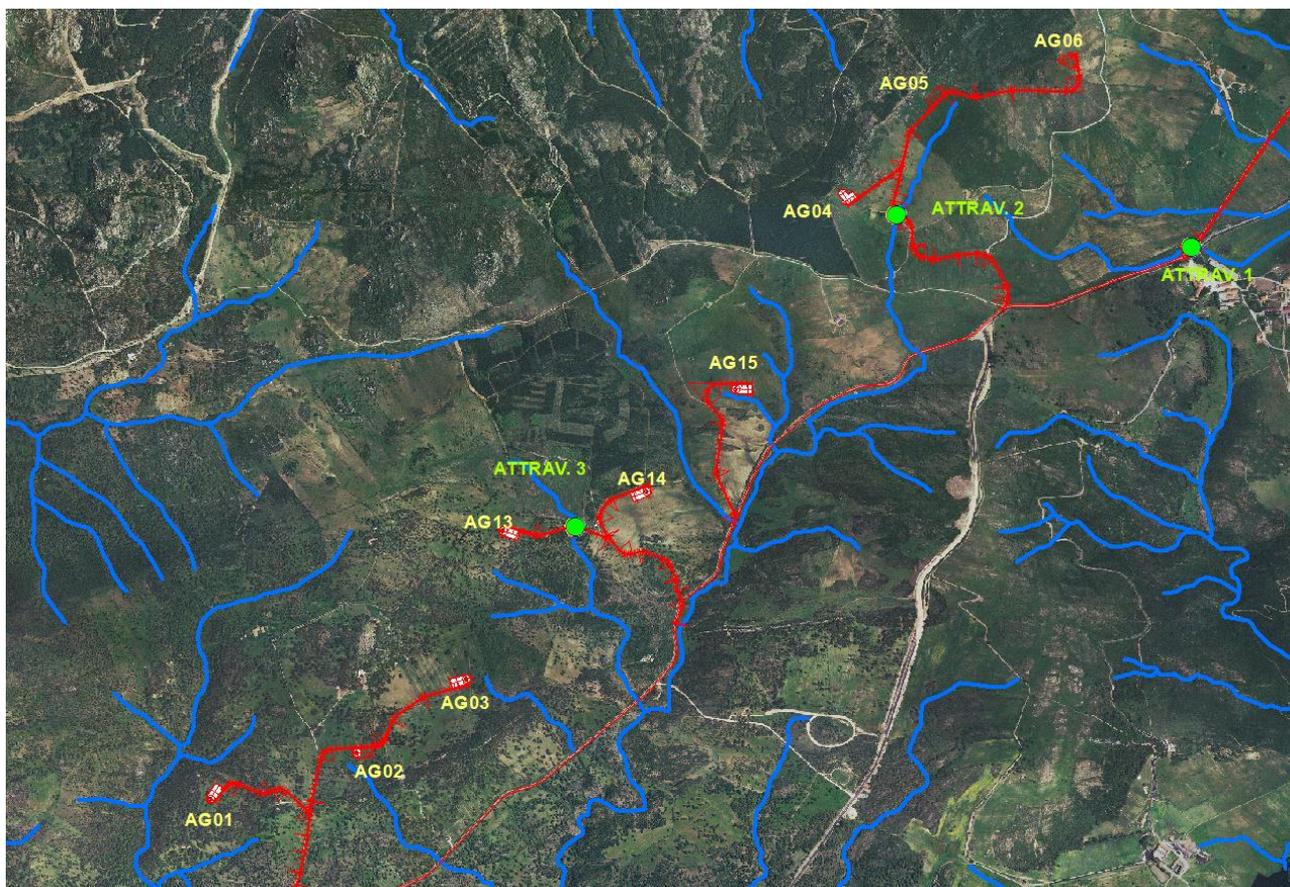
Planimetria con individuazione degli attraversamenti
